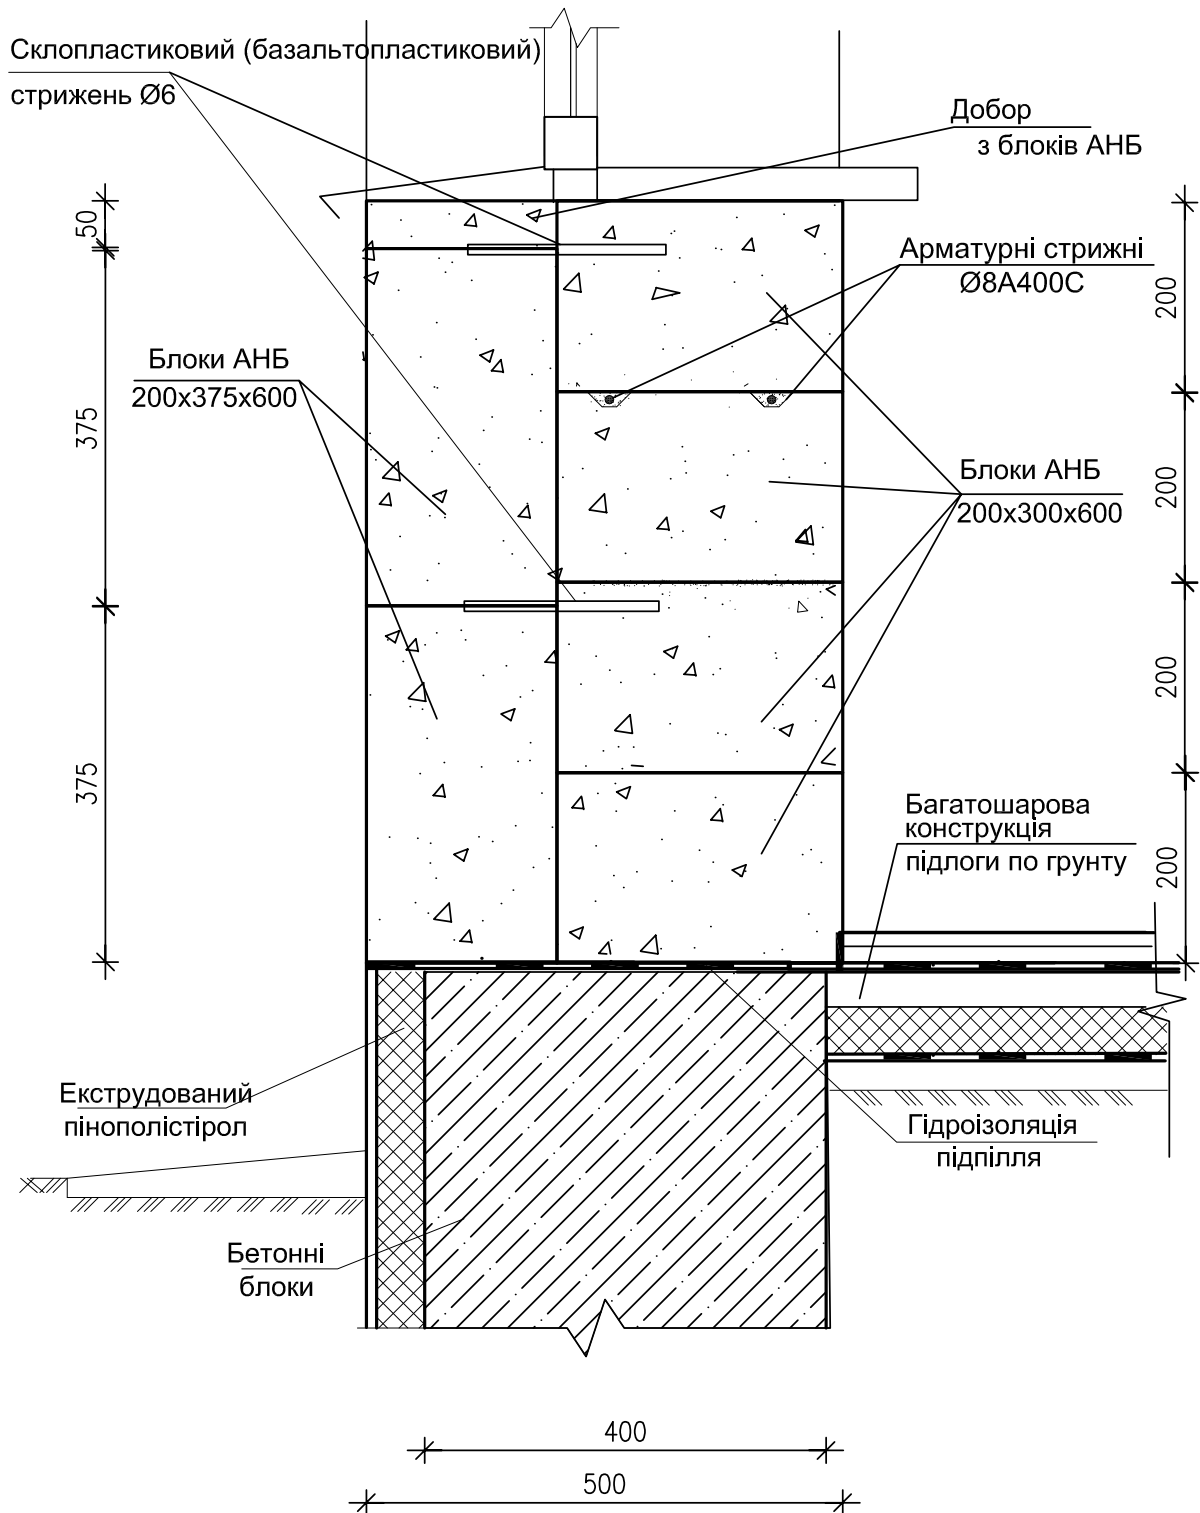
12-2. Двошарова стіна першого типу. Вузол спирання стіни на блок фундаменту
